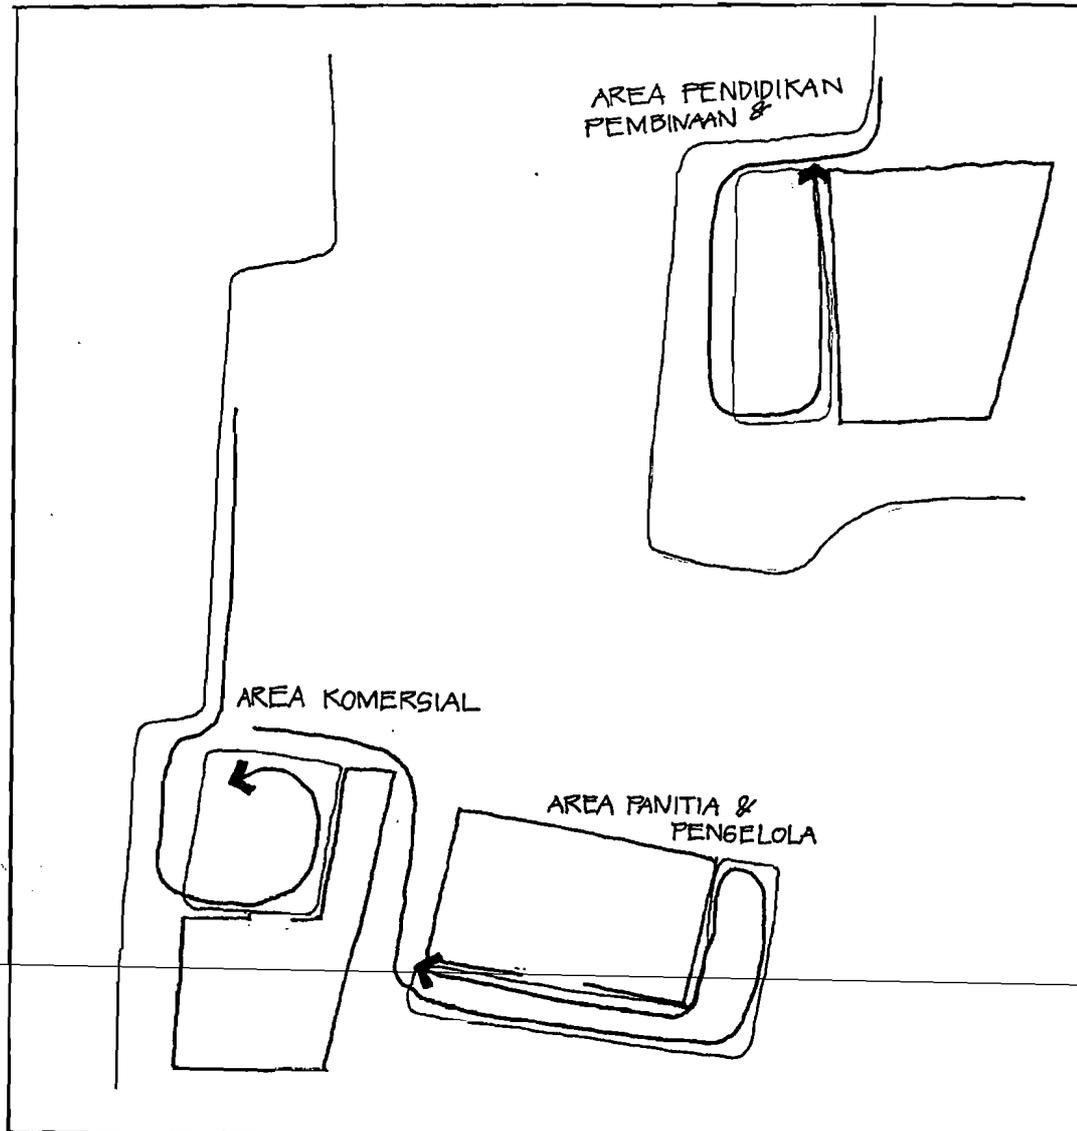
Pencapaian ke bangunan dengan sirkulasi langsung
